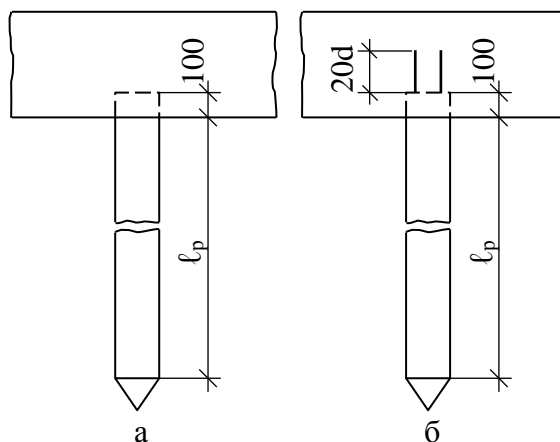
Конструкції з'єднання фундаменту з ростверком: а – шарнірна; б – жорстка
